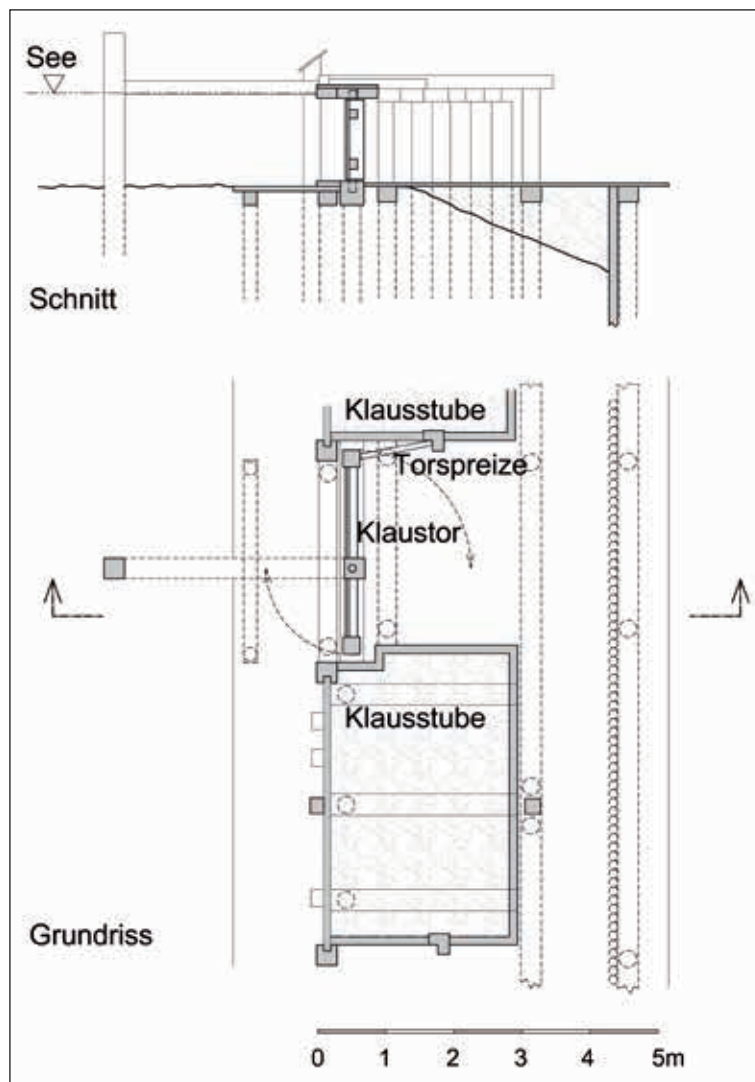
Grundriss und Schnitt eines Klaustores, Planzeichnung: Autor
